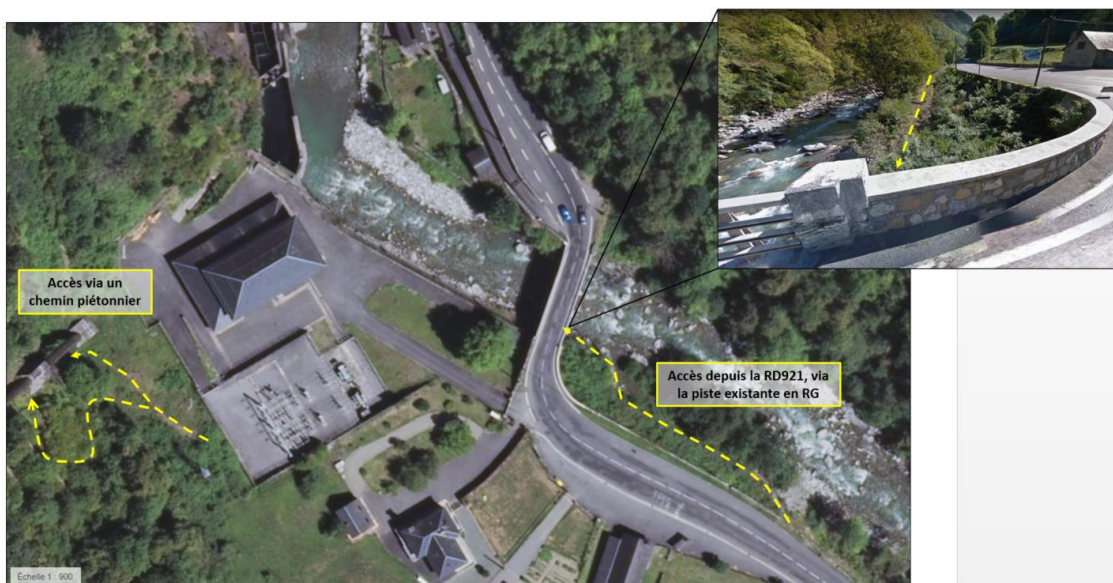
Carte des accès aux zones de travaux sur le site de Pont de la Reine
